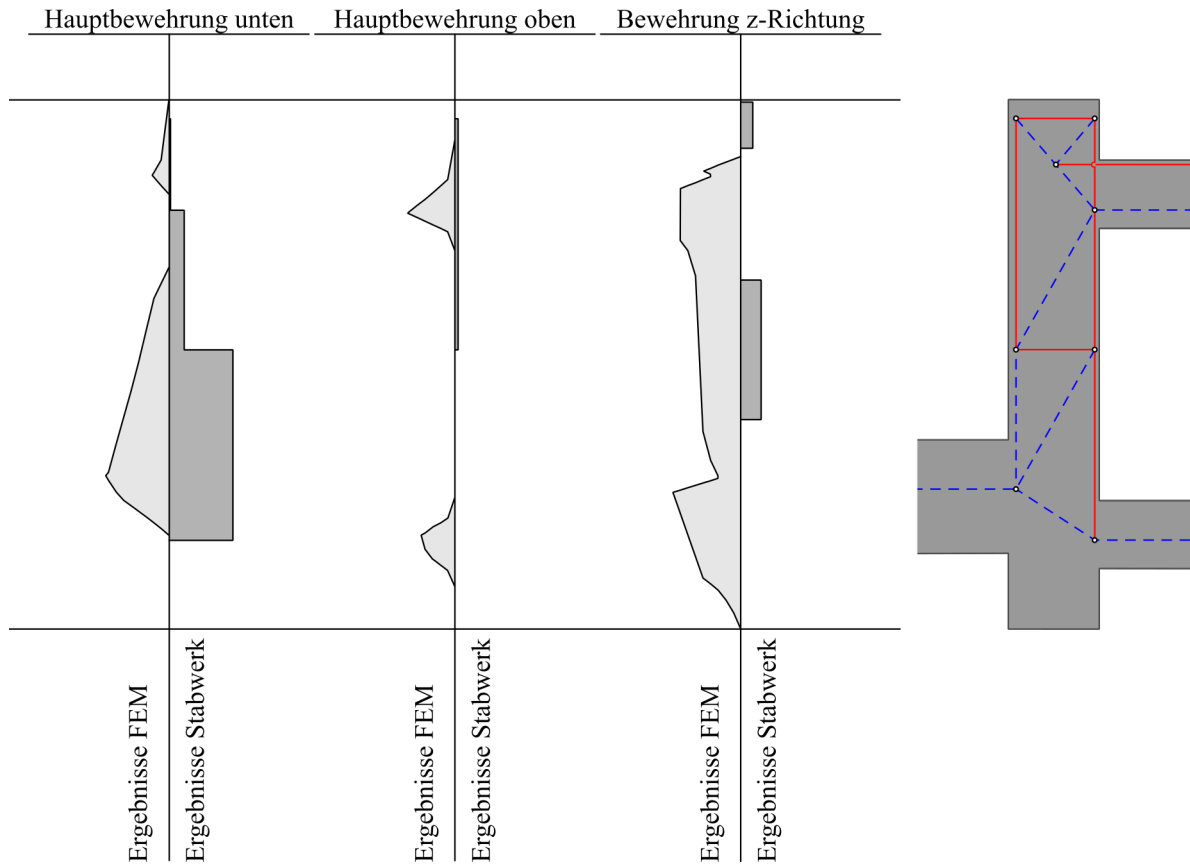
Variante 2 Lastfall 1 - Bewehrungsvergleich
